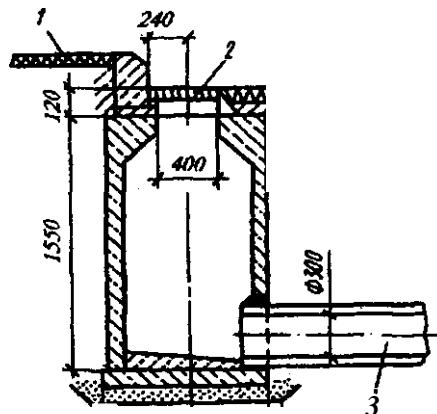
Железобетонный дождеприемник: 1- тротуар, 2 – решетка, 3 – соединительный трубопровод
